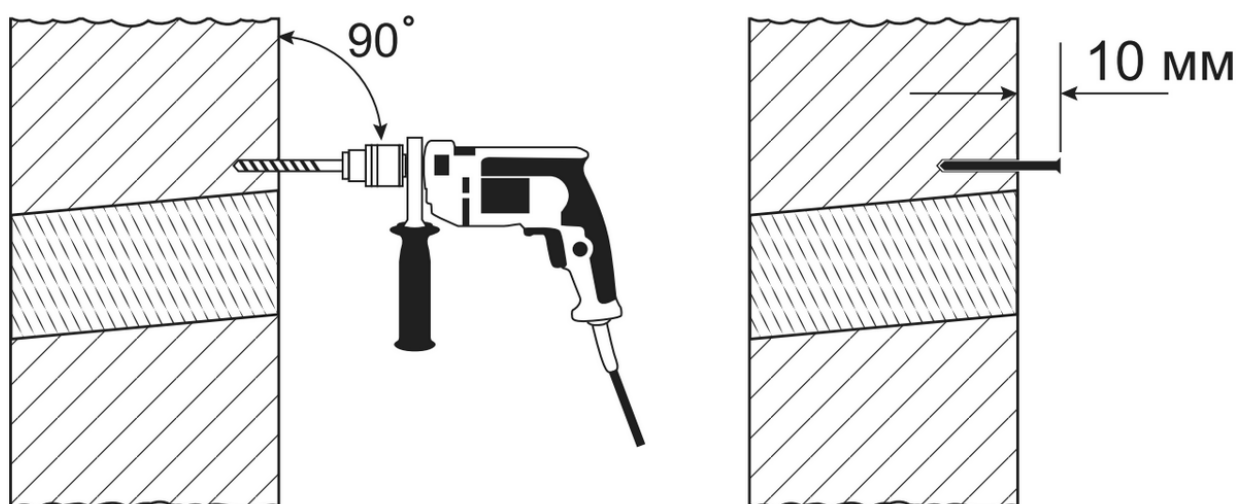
Сверление отверстий под дюбель-гвозди (анкерные болты)
